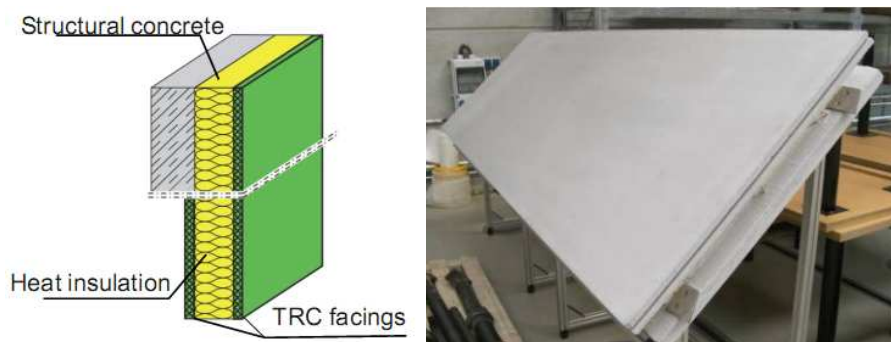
Sezione dei pannelli sandwich con facce in TRC e loro applicazione
